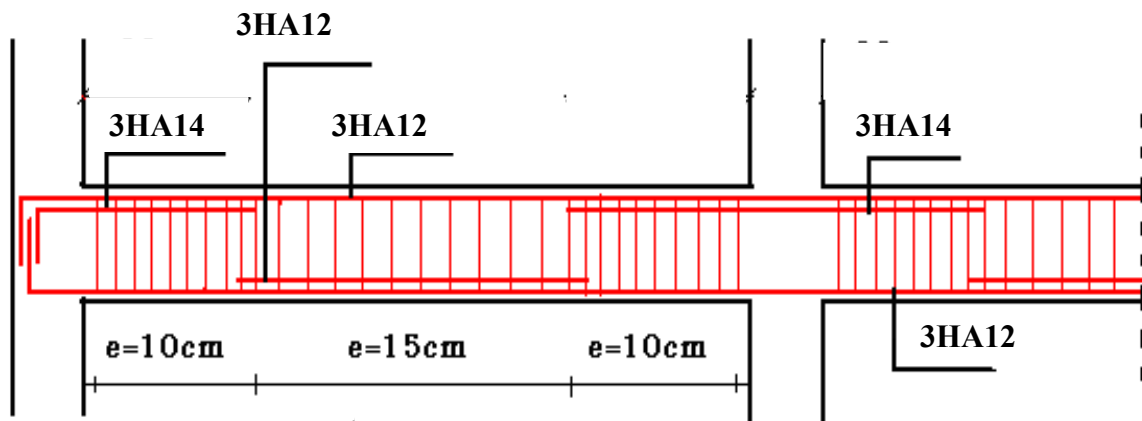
Exemple de dispositions constructives de la poutre principale.
